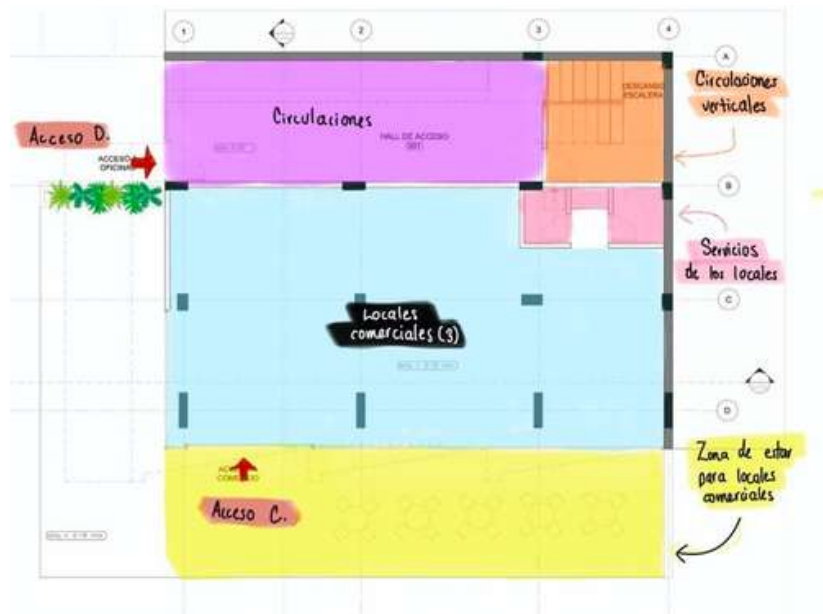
Intervención de imagen con análisis de zonificación. Fuente: Autoría propia.
